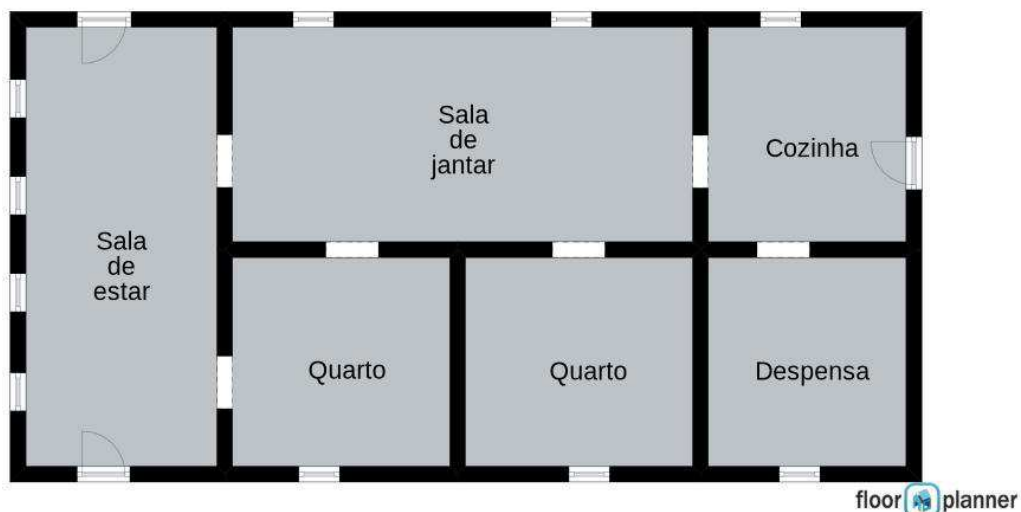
Reprodução da planta baixa do chalé de Vicente Xavier. Construção do autor. Fonte: Floorplanner.
